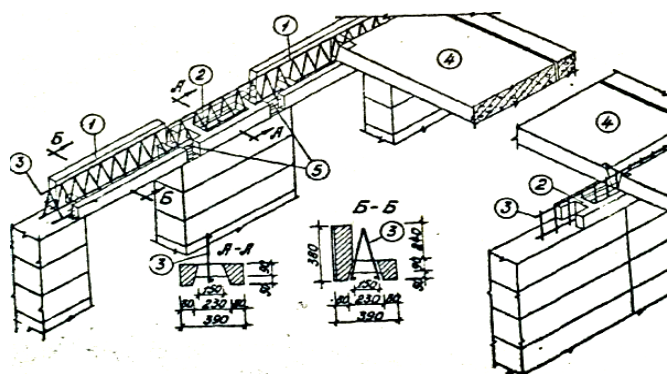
Конструкция *СбМт* ригелей без днаща, предусмотренных РСН-10-79 [62, с. 143], РСН-10-87 [102, с. 24]: 1 - сборные элементы ригелей наружных стен; 2 - то же внутренних стен; 3 - арматурные каркасы монолитных обвязок; 4 - панели перекрытий; 5 - стыки сборных элементов.
